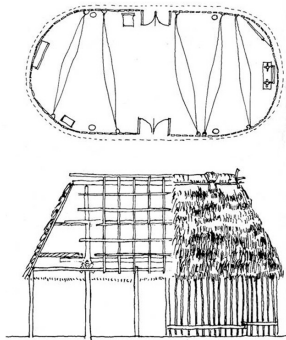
Planta y sección-alzado de una casa maya tipo. Tomadas de F. J. López Morales (1993).
